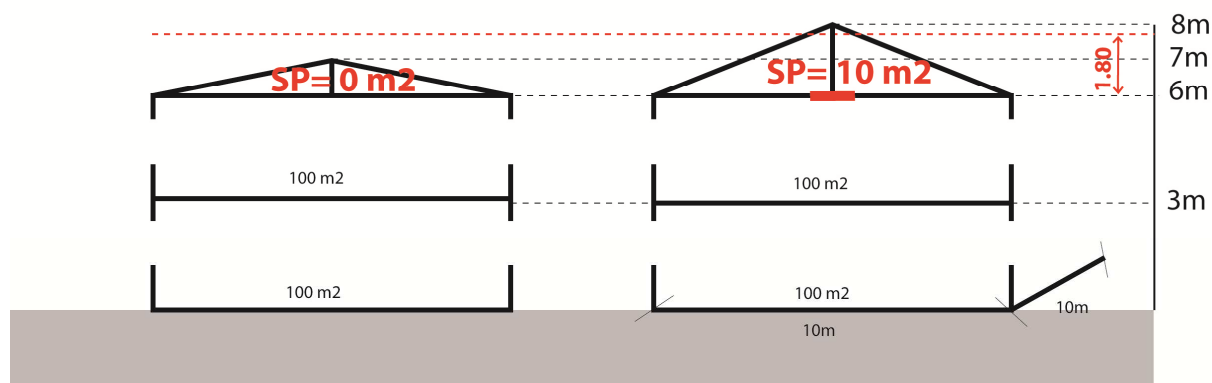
Surface de plancher générée par l'augmentation de la hauteur à 8 m
